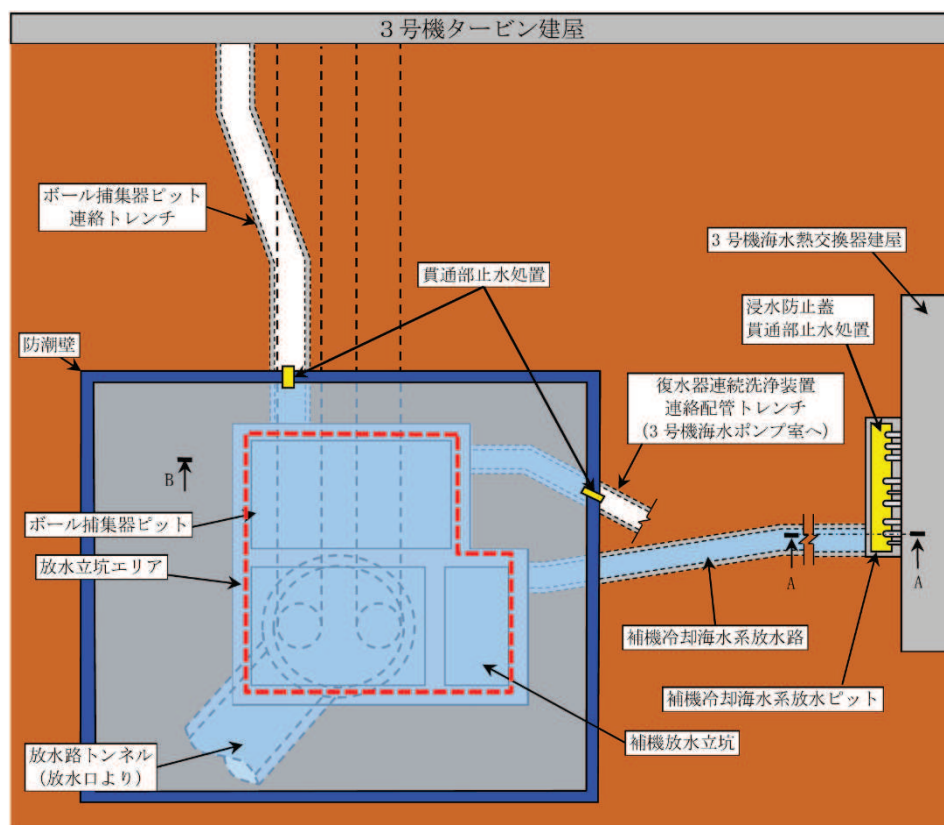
3号機 放水立坑 浸水対策配置図（平面図）
